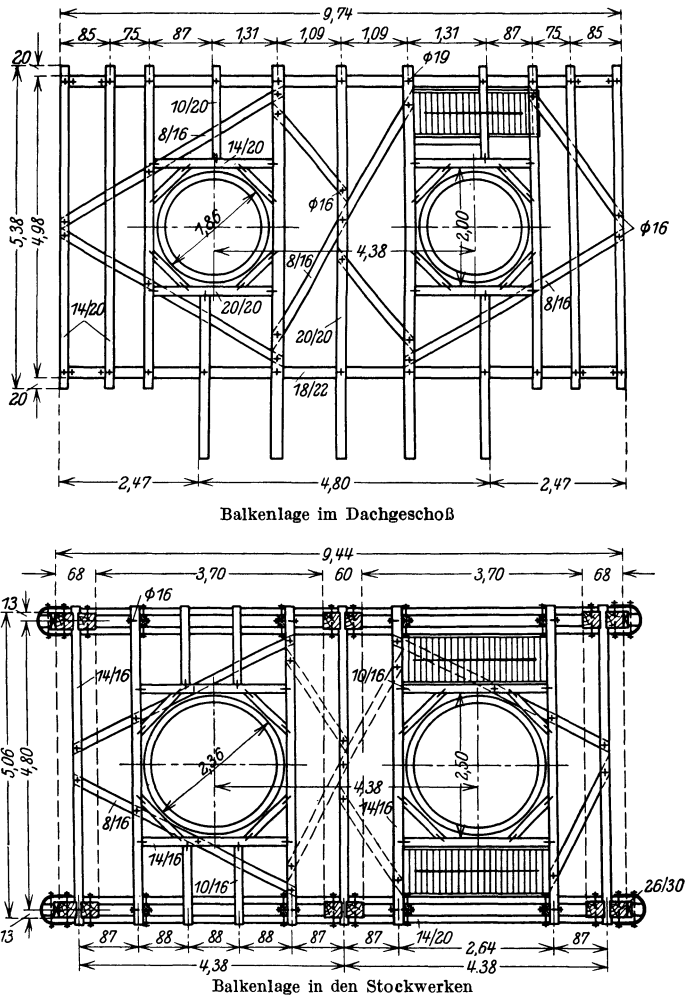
Anordnung der Balkenlagen und Horizontalverbände.
